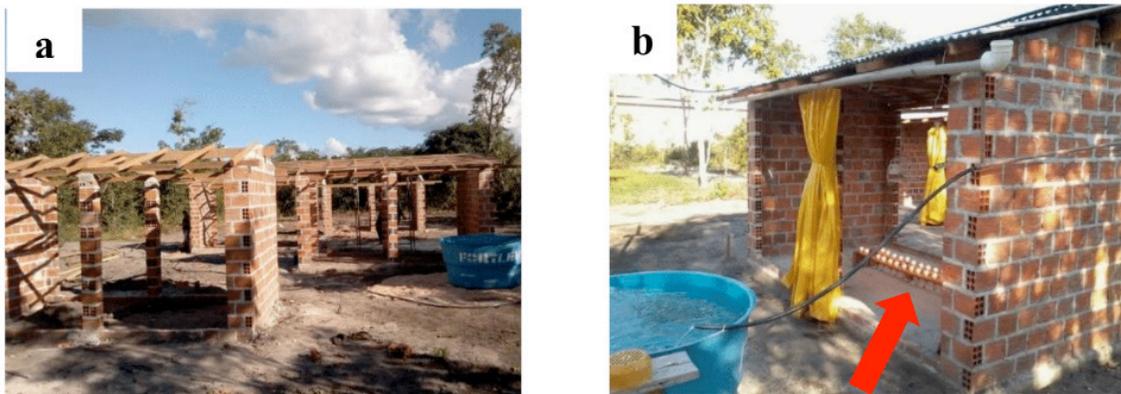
Construção das instalações de modelo reduzido (a) e visão das lâmpadas que simularam o calor dos frangos (b).
